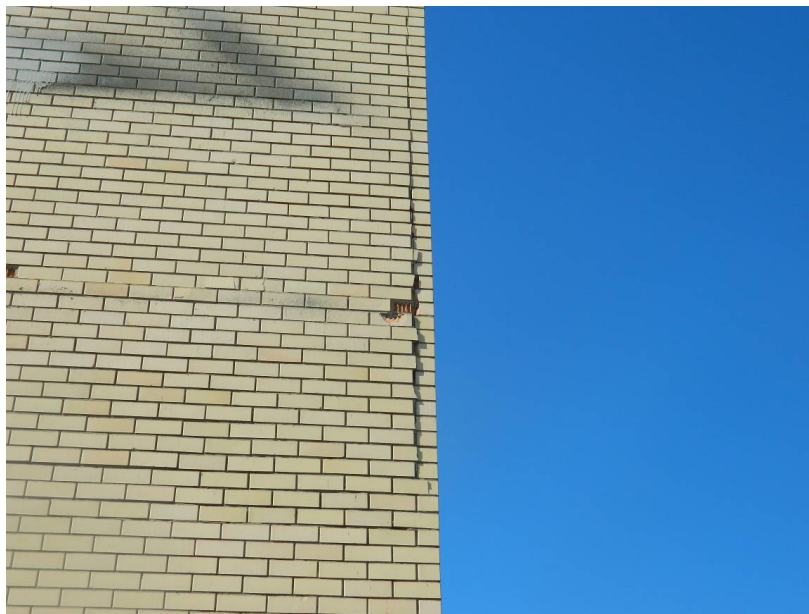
Вертикальная трещина шириной раскрытия до 3 мм стены фасада. Разрушение материала кирпичной кладки
